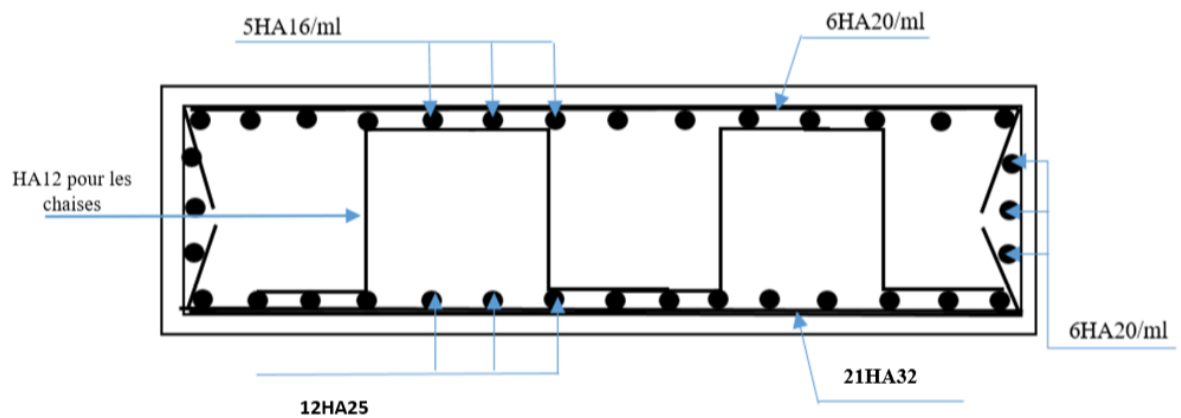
FERRAILLAGE DE LA SEMELLE
